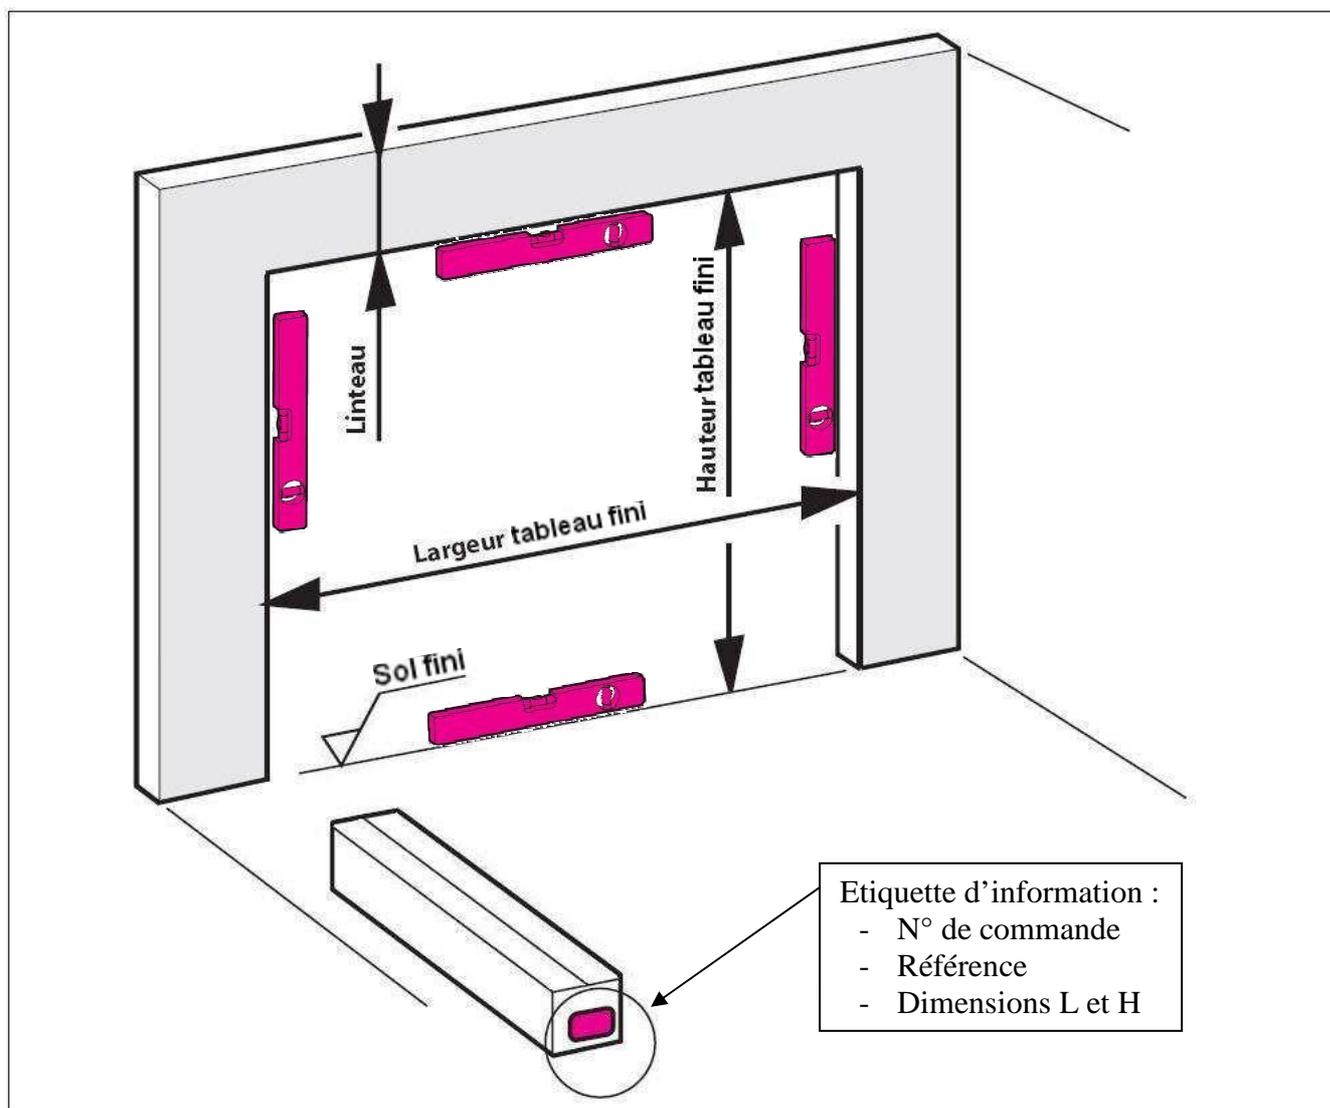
Vue d'ensemble pour les mesures de contrôle
